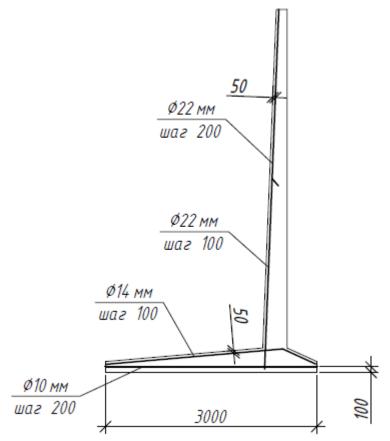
Схема армирования монолитной подпорной стены продольной рабочей арматурой.
